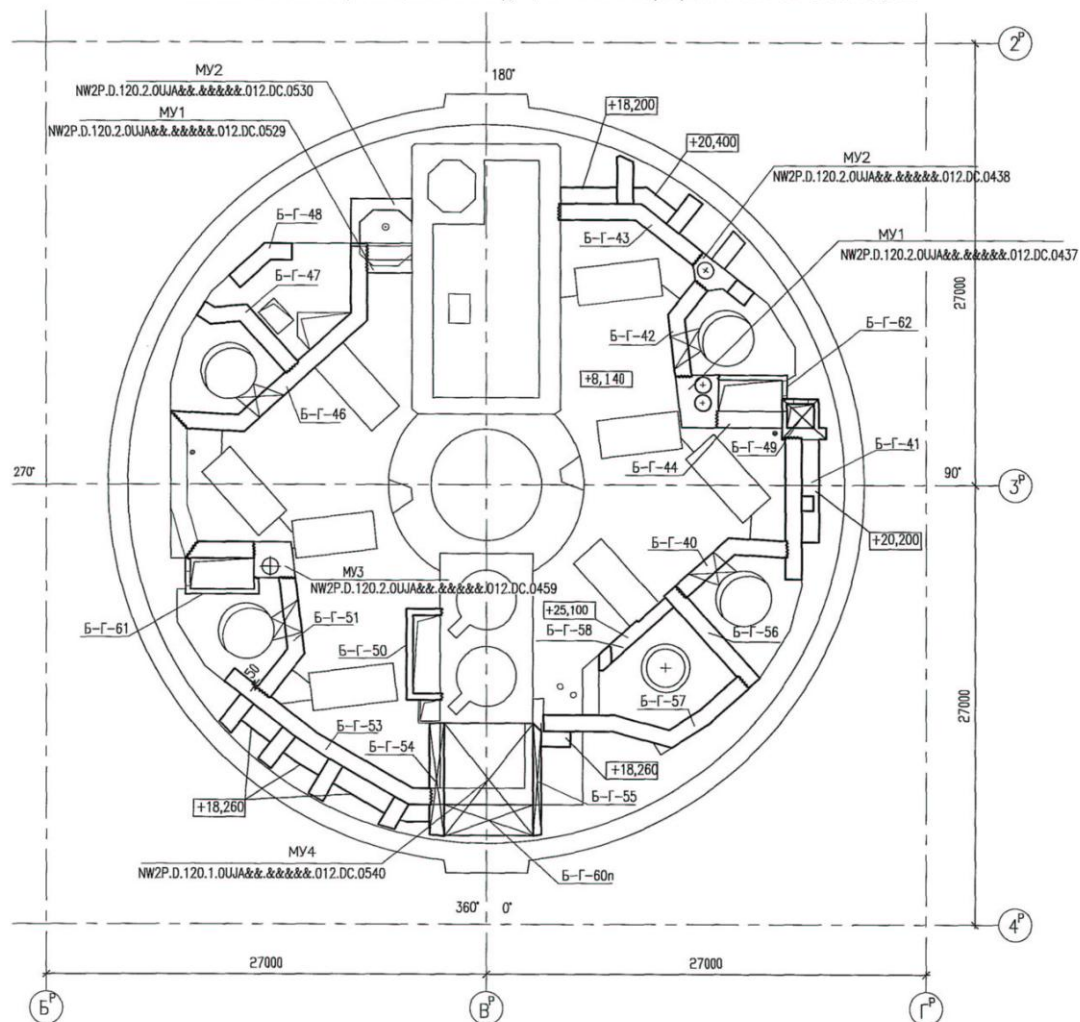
Схема размещения конструкций стен ЗЛА здания реактора 20UJA на отм. +25.100
